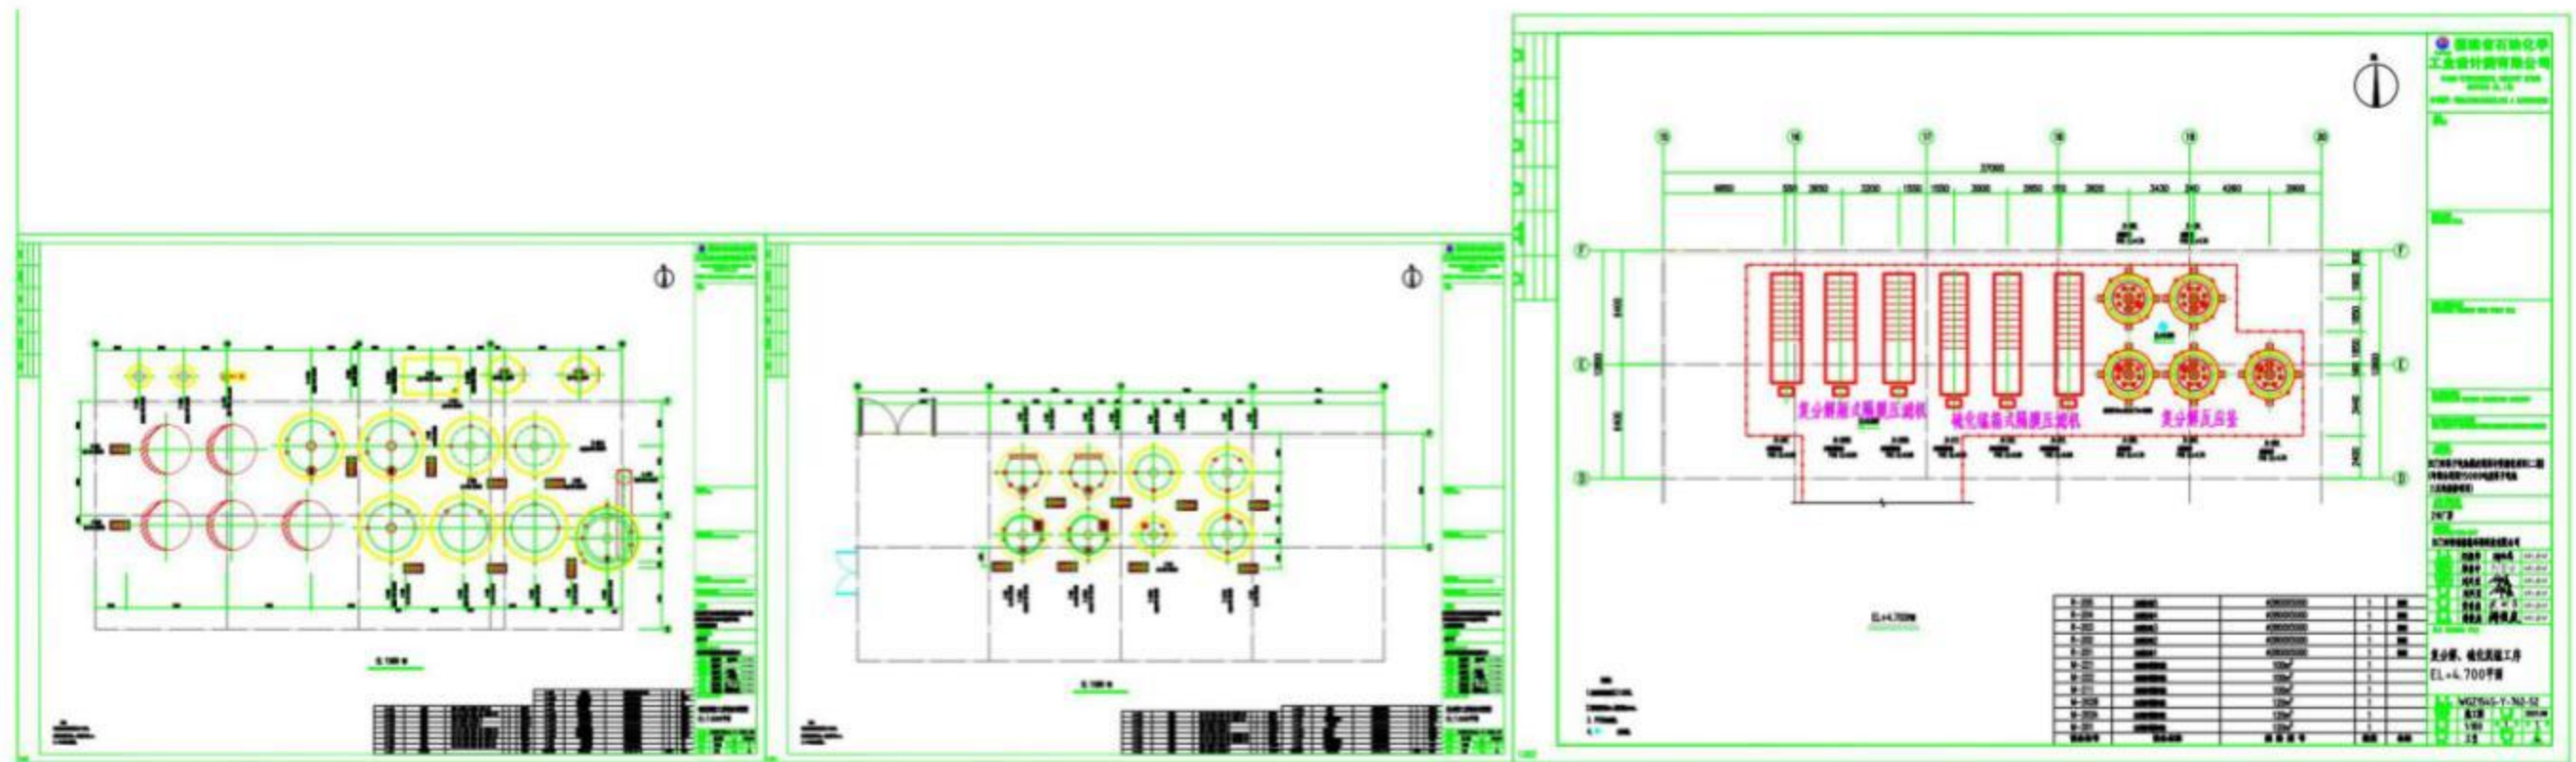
2#厂房-复分解、硫化沉锰区域平面布置图
